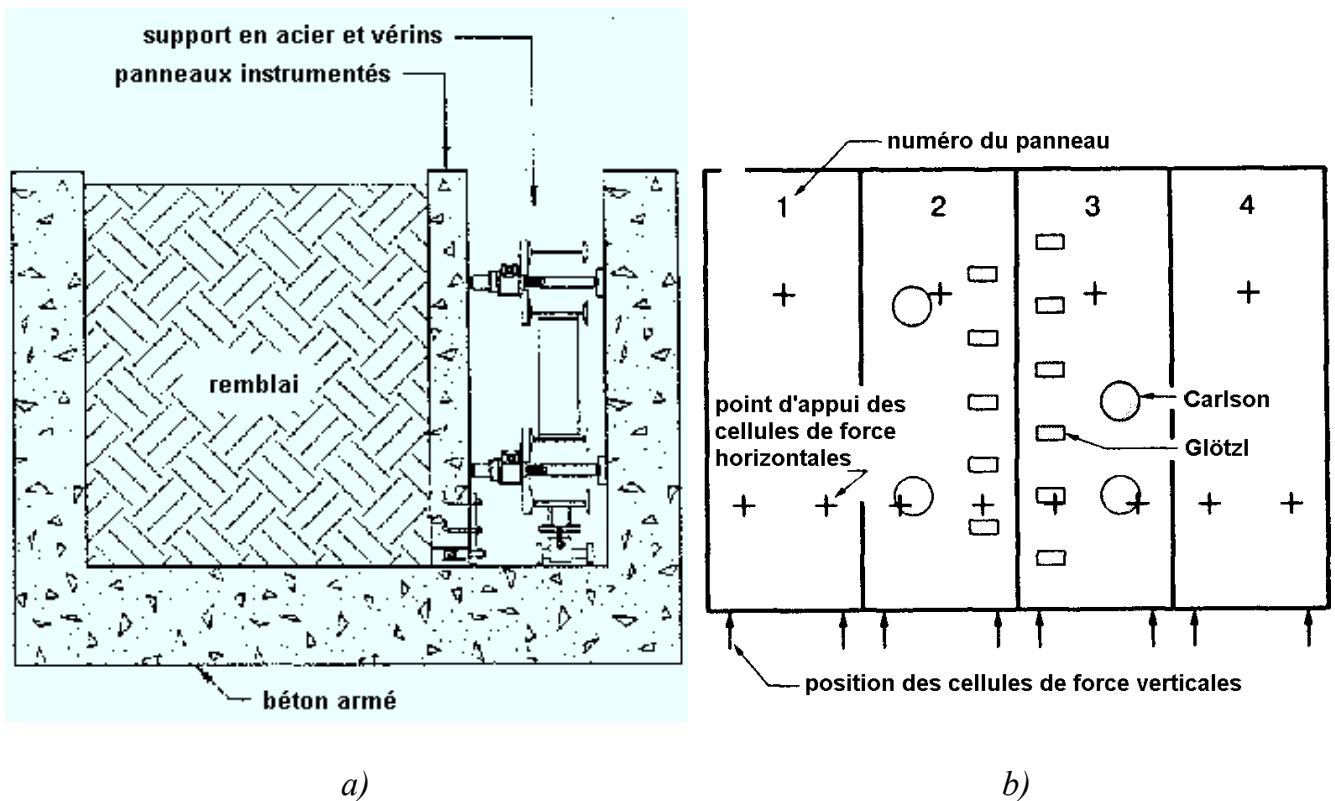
Structure de mur de soutènement en semi-grandeur (Virginia Tech Instrumented Retaining Wall Test Facility - d'après Filz et Duncan, 1992). a) Section transversale contenant la paroi instrumentée ; b) Disposition des capteurs de pression de sol et des cellules de force dans le plan de la paroi instrumentée.
